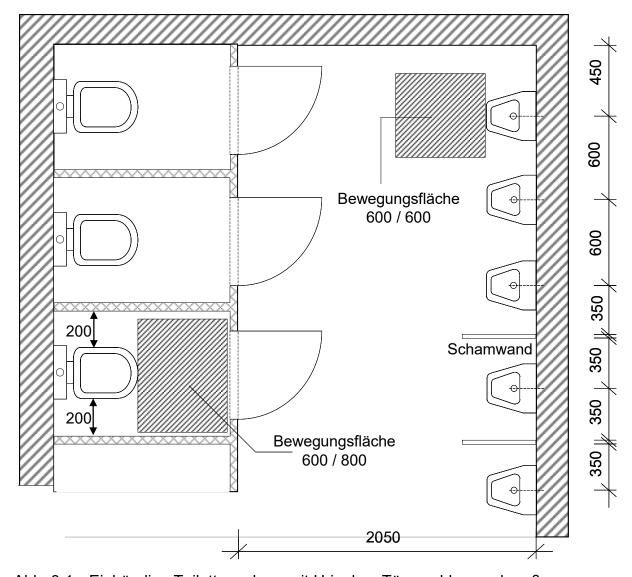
Einbündige Toilettenanlage mit Urinalen, Türanschlag nach außen (Maße in mm)
